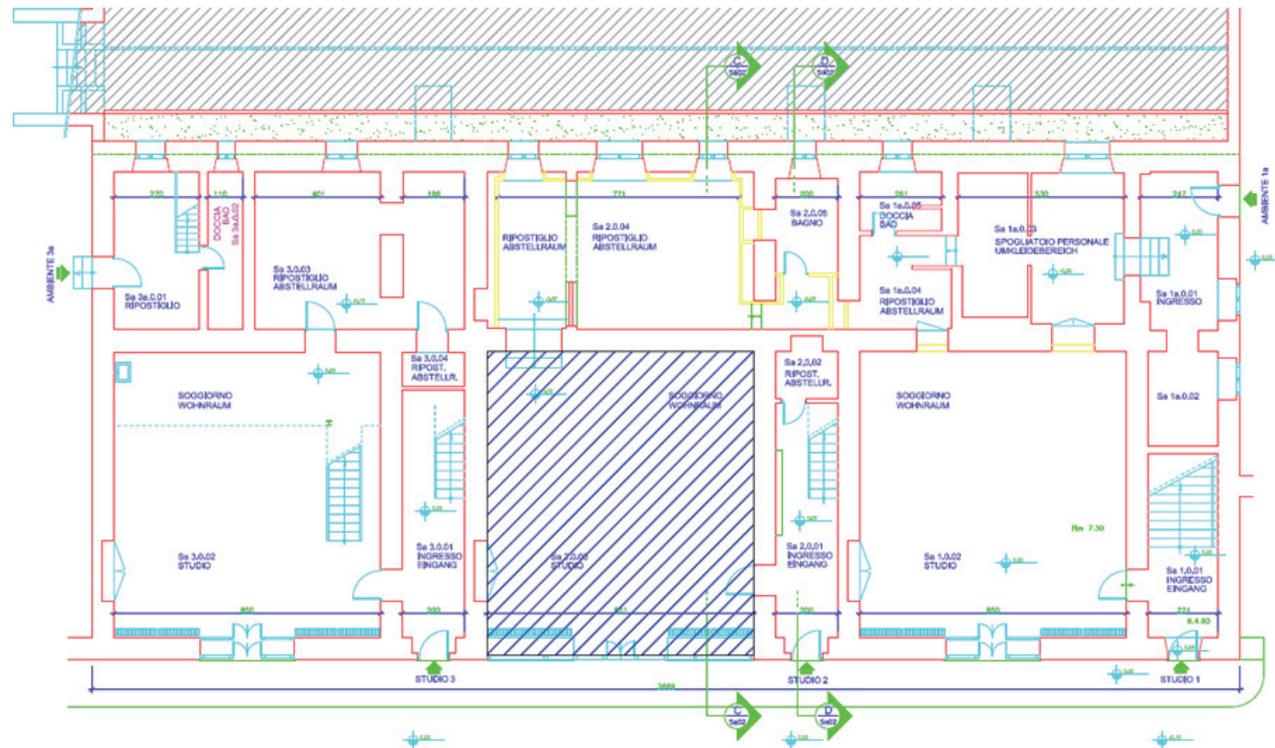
Zoneneinteilung Grundriss Erdgeschoss (ohne Maßstab)
